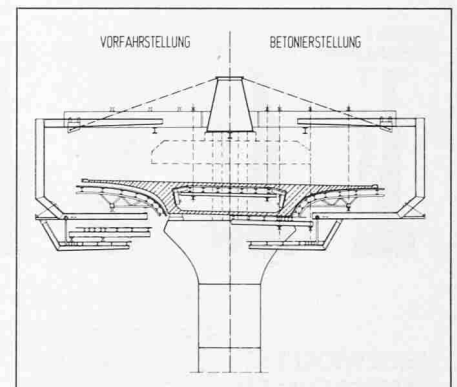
Eingeschaltes Tragwerk von Bild 1 - mit obenliegendem Rüstträger
